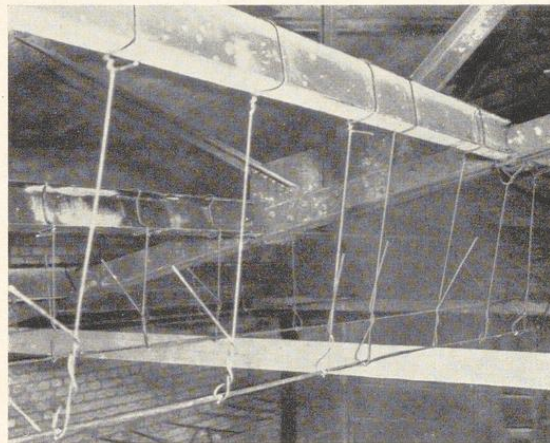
Sachgemäße Abhängung an eisernem Dachstuhl
